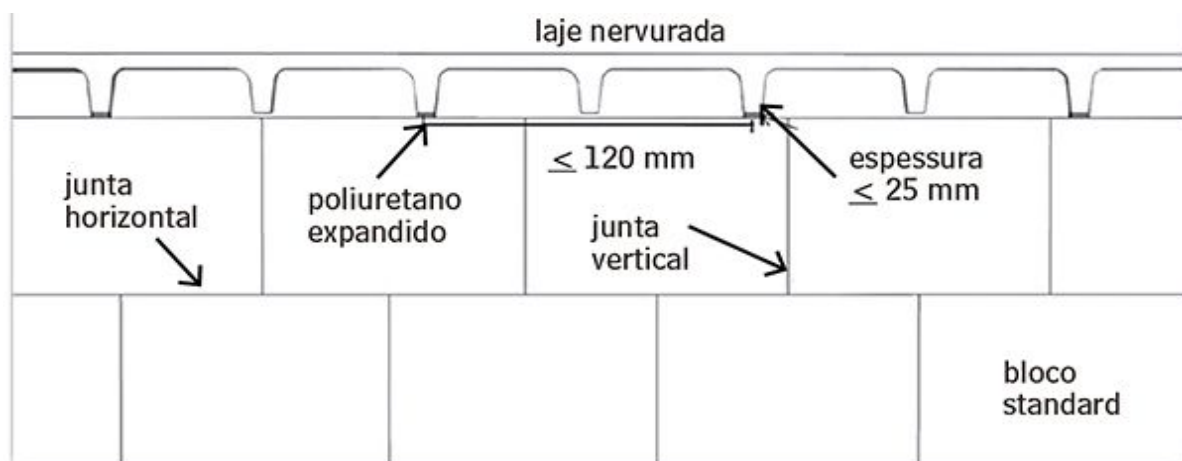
Ligação entre os blocos de gesso e a laje nervurada
